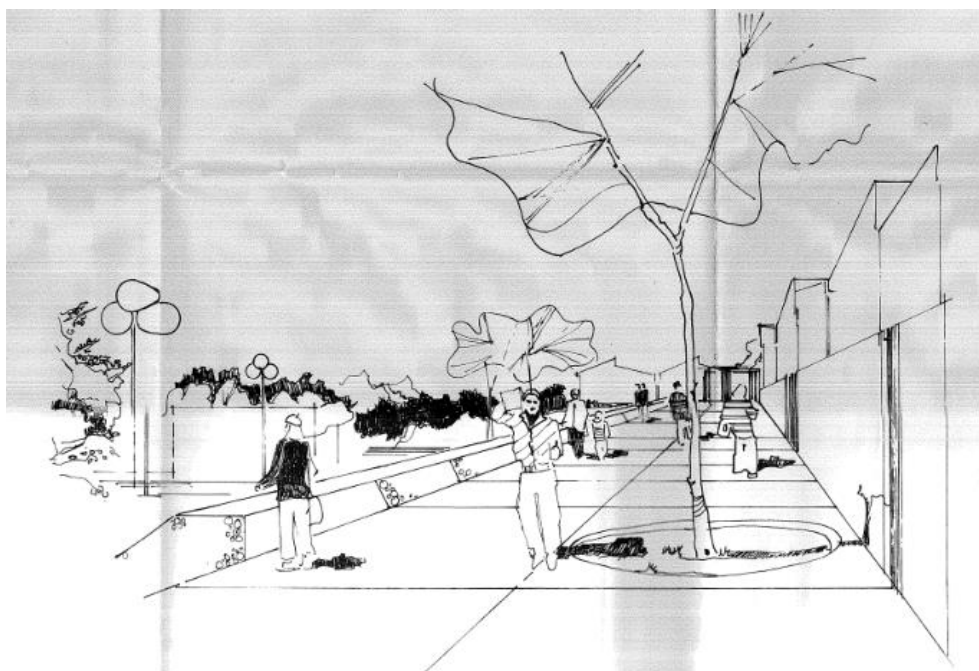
Estudio de detalle del Espiritu Santo (1983). Vista parcial del plano nº 8 de secciones.
